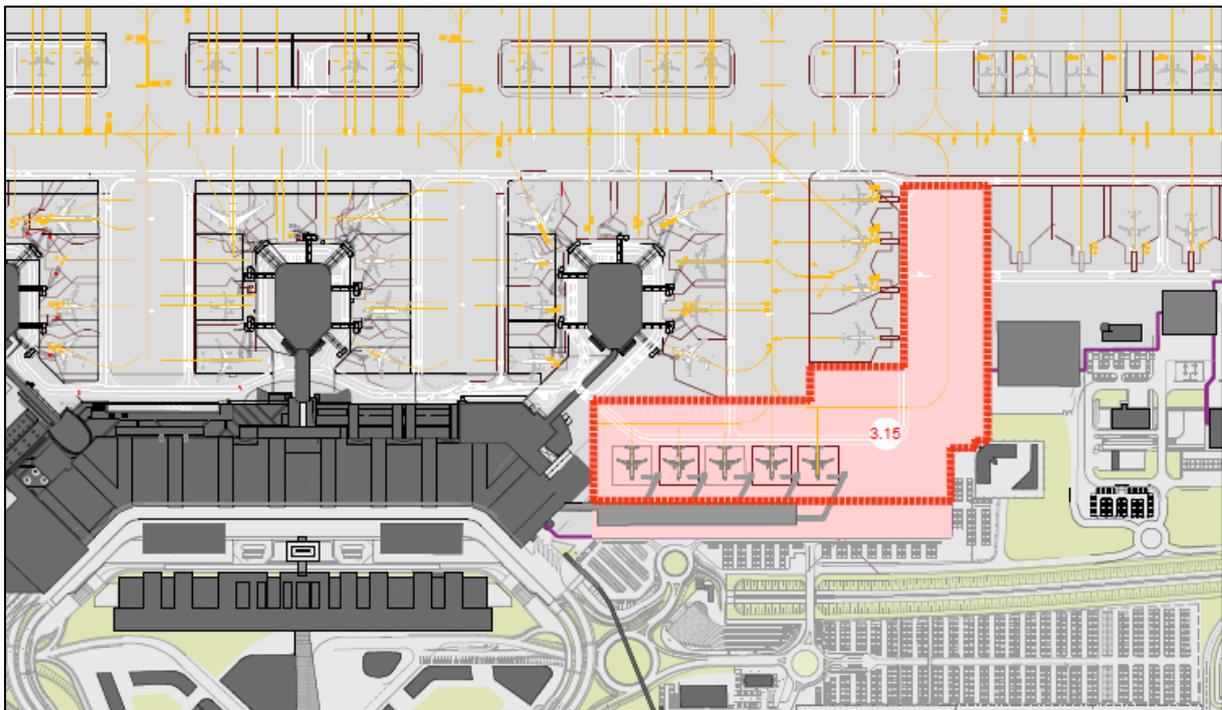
Intervento C1: Sistemazione aree piazzale pier sud
